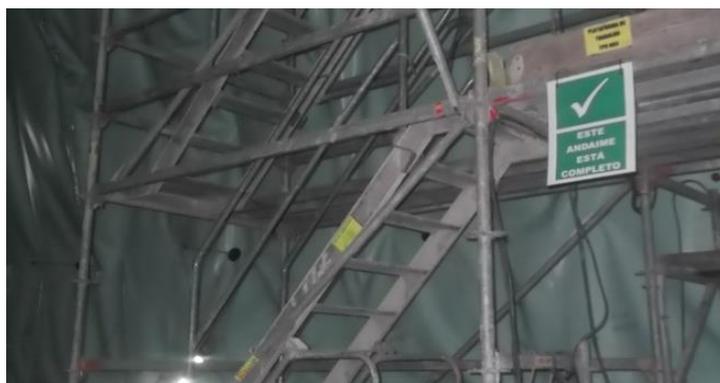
Escadas interiores e passadiços de acesso às estruturas
